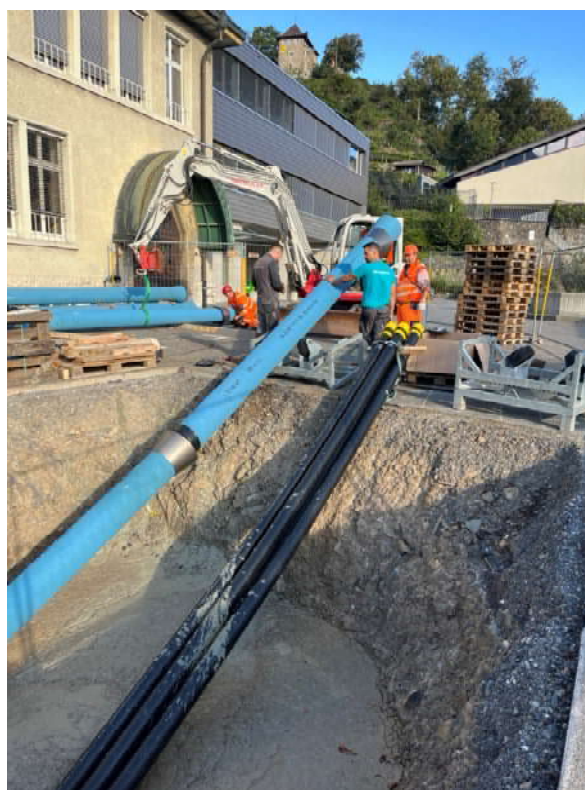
"mont and pull" aerea di cantiere ridotta al minimo
